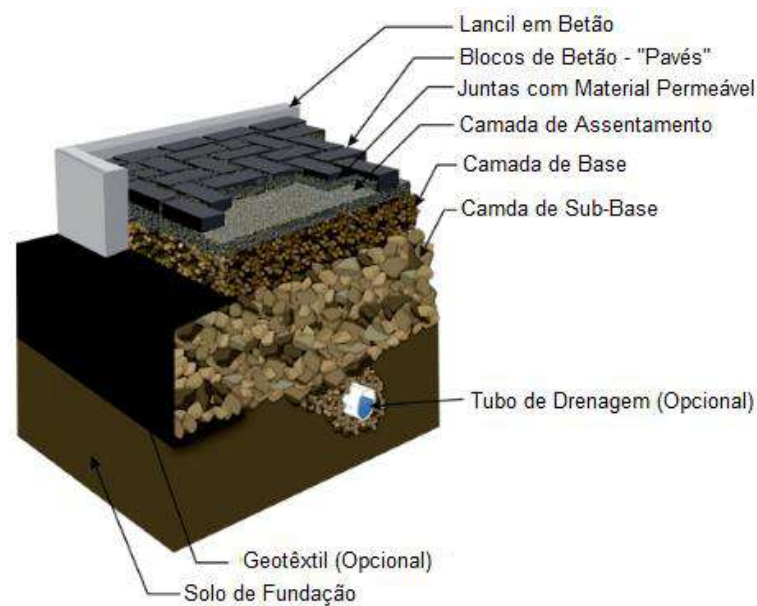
Secção transversal típica de pavimento permeável (STORMWATER CENTER, s.d.)
